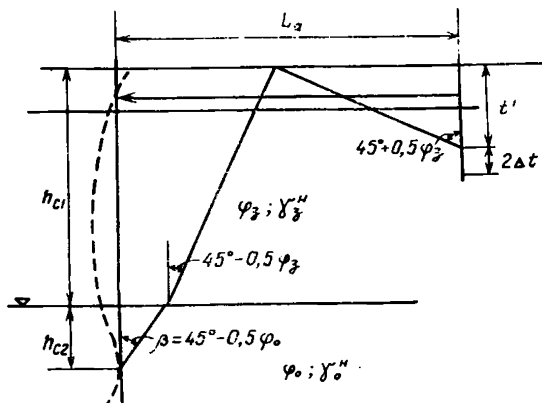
Схема для определения расстояния  $L_a$  между лицевой стенкой и анкерными опорами:
